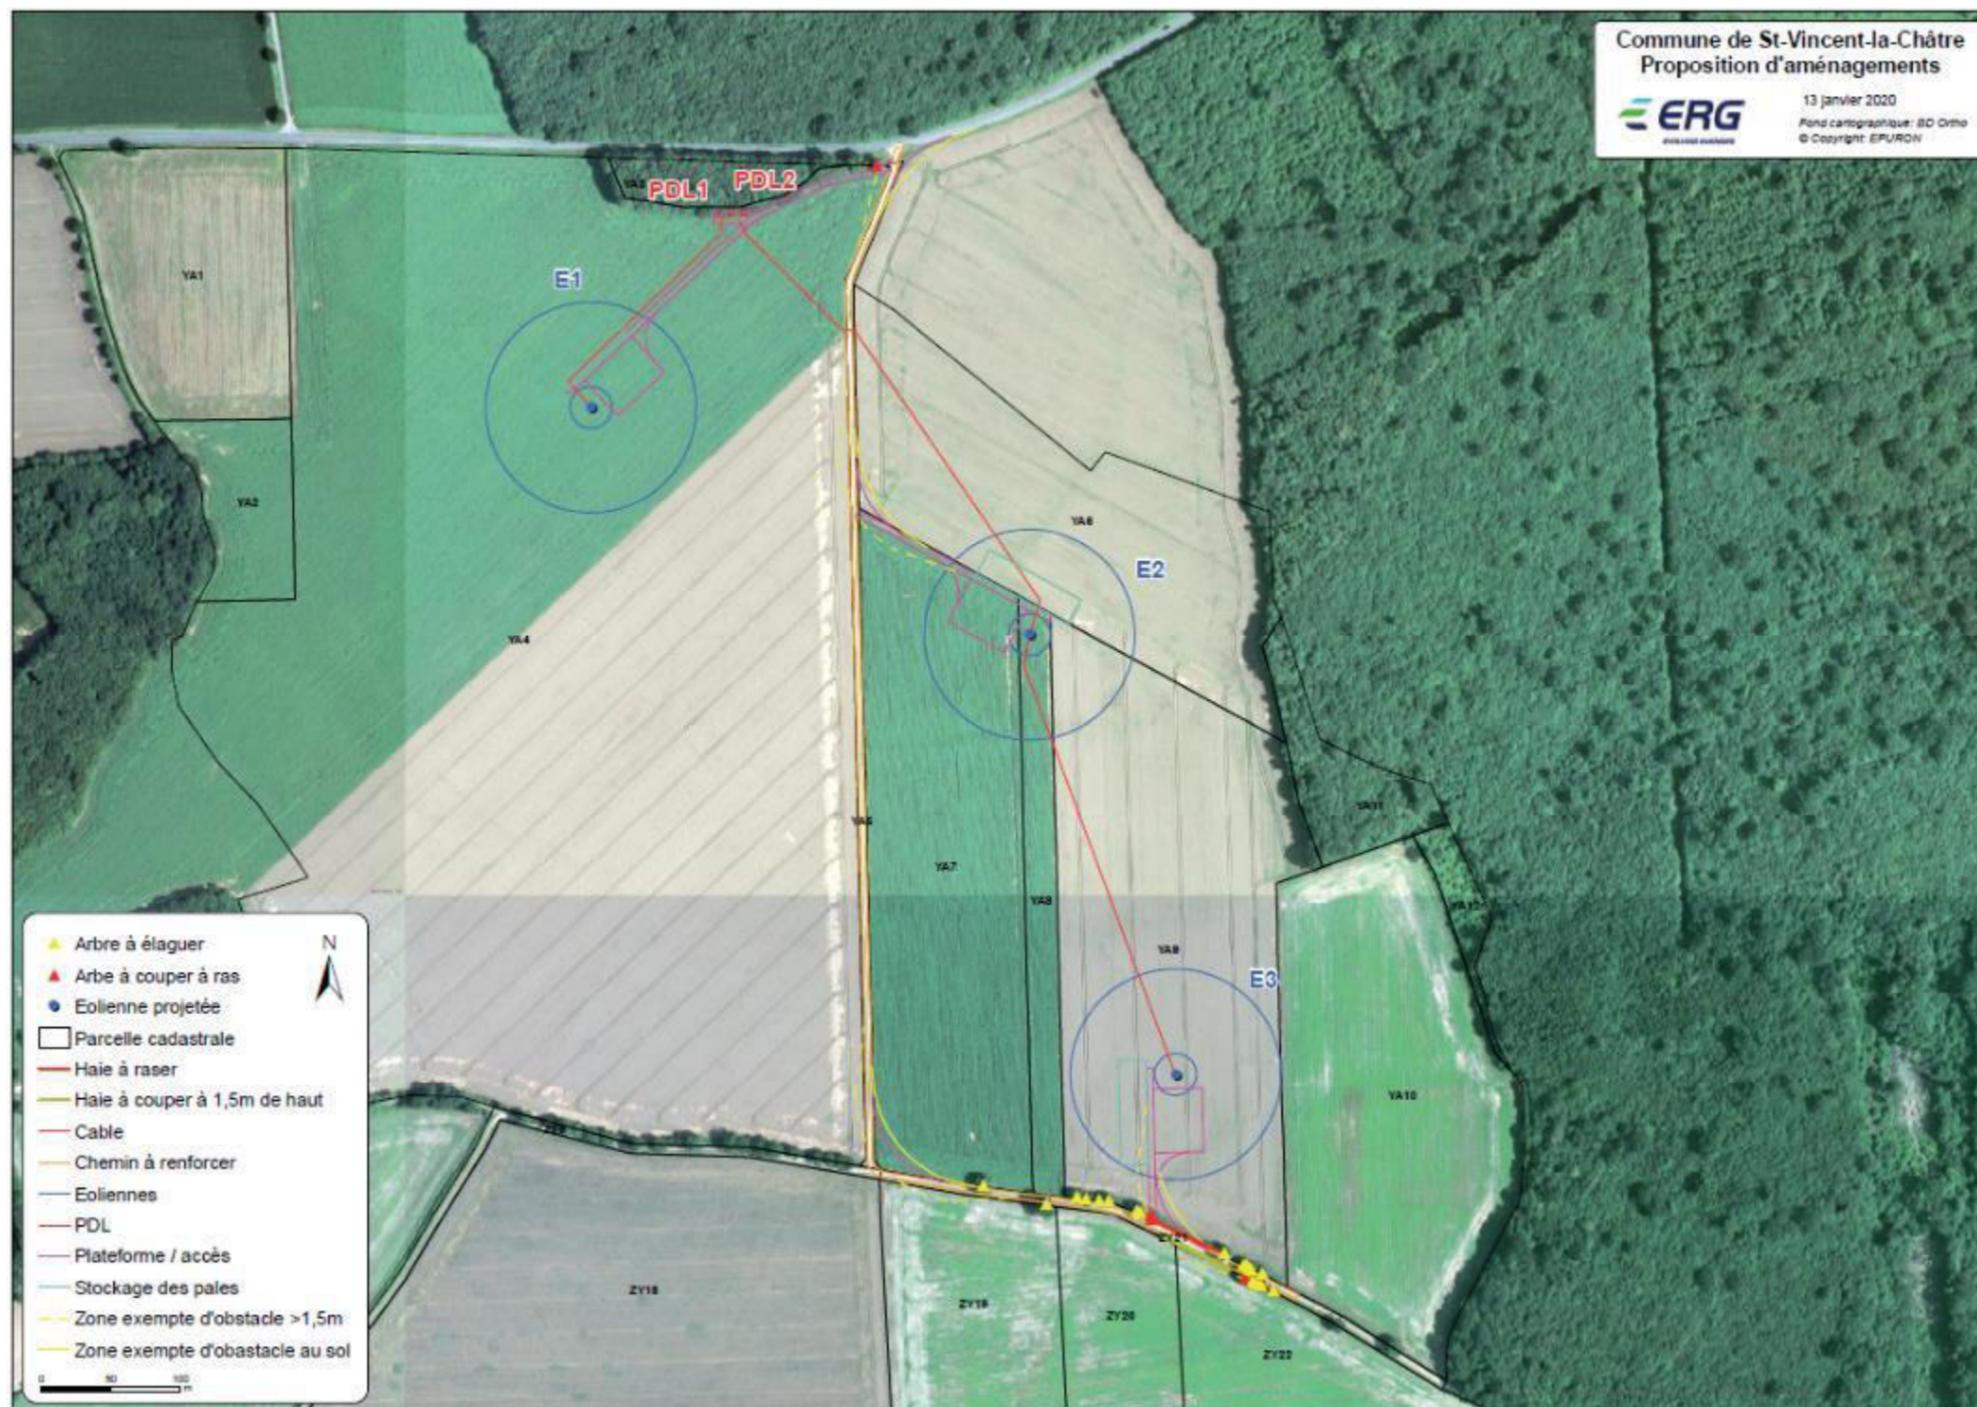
Plan d'ensemble laissant apparaître les travaux de coupe et de taille de végétation nécessaires à la construction du parc éolien
